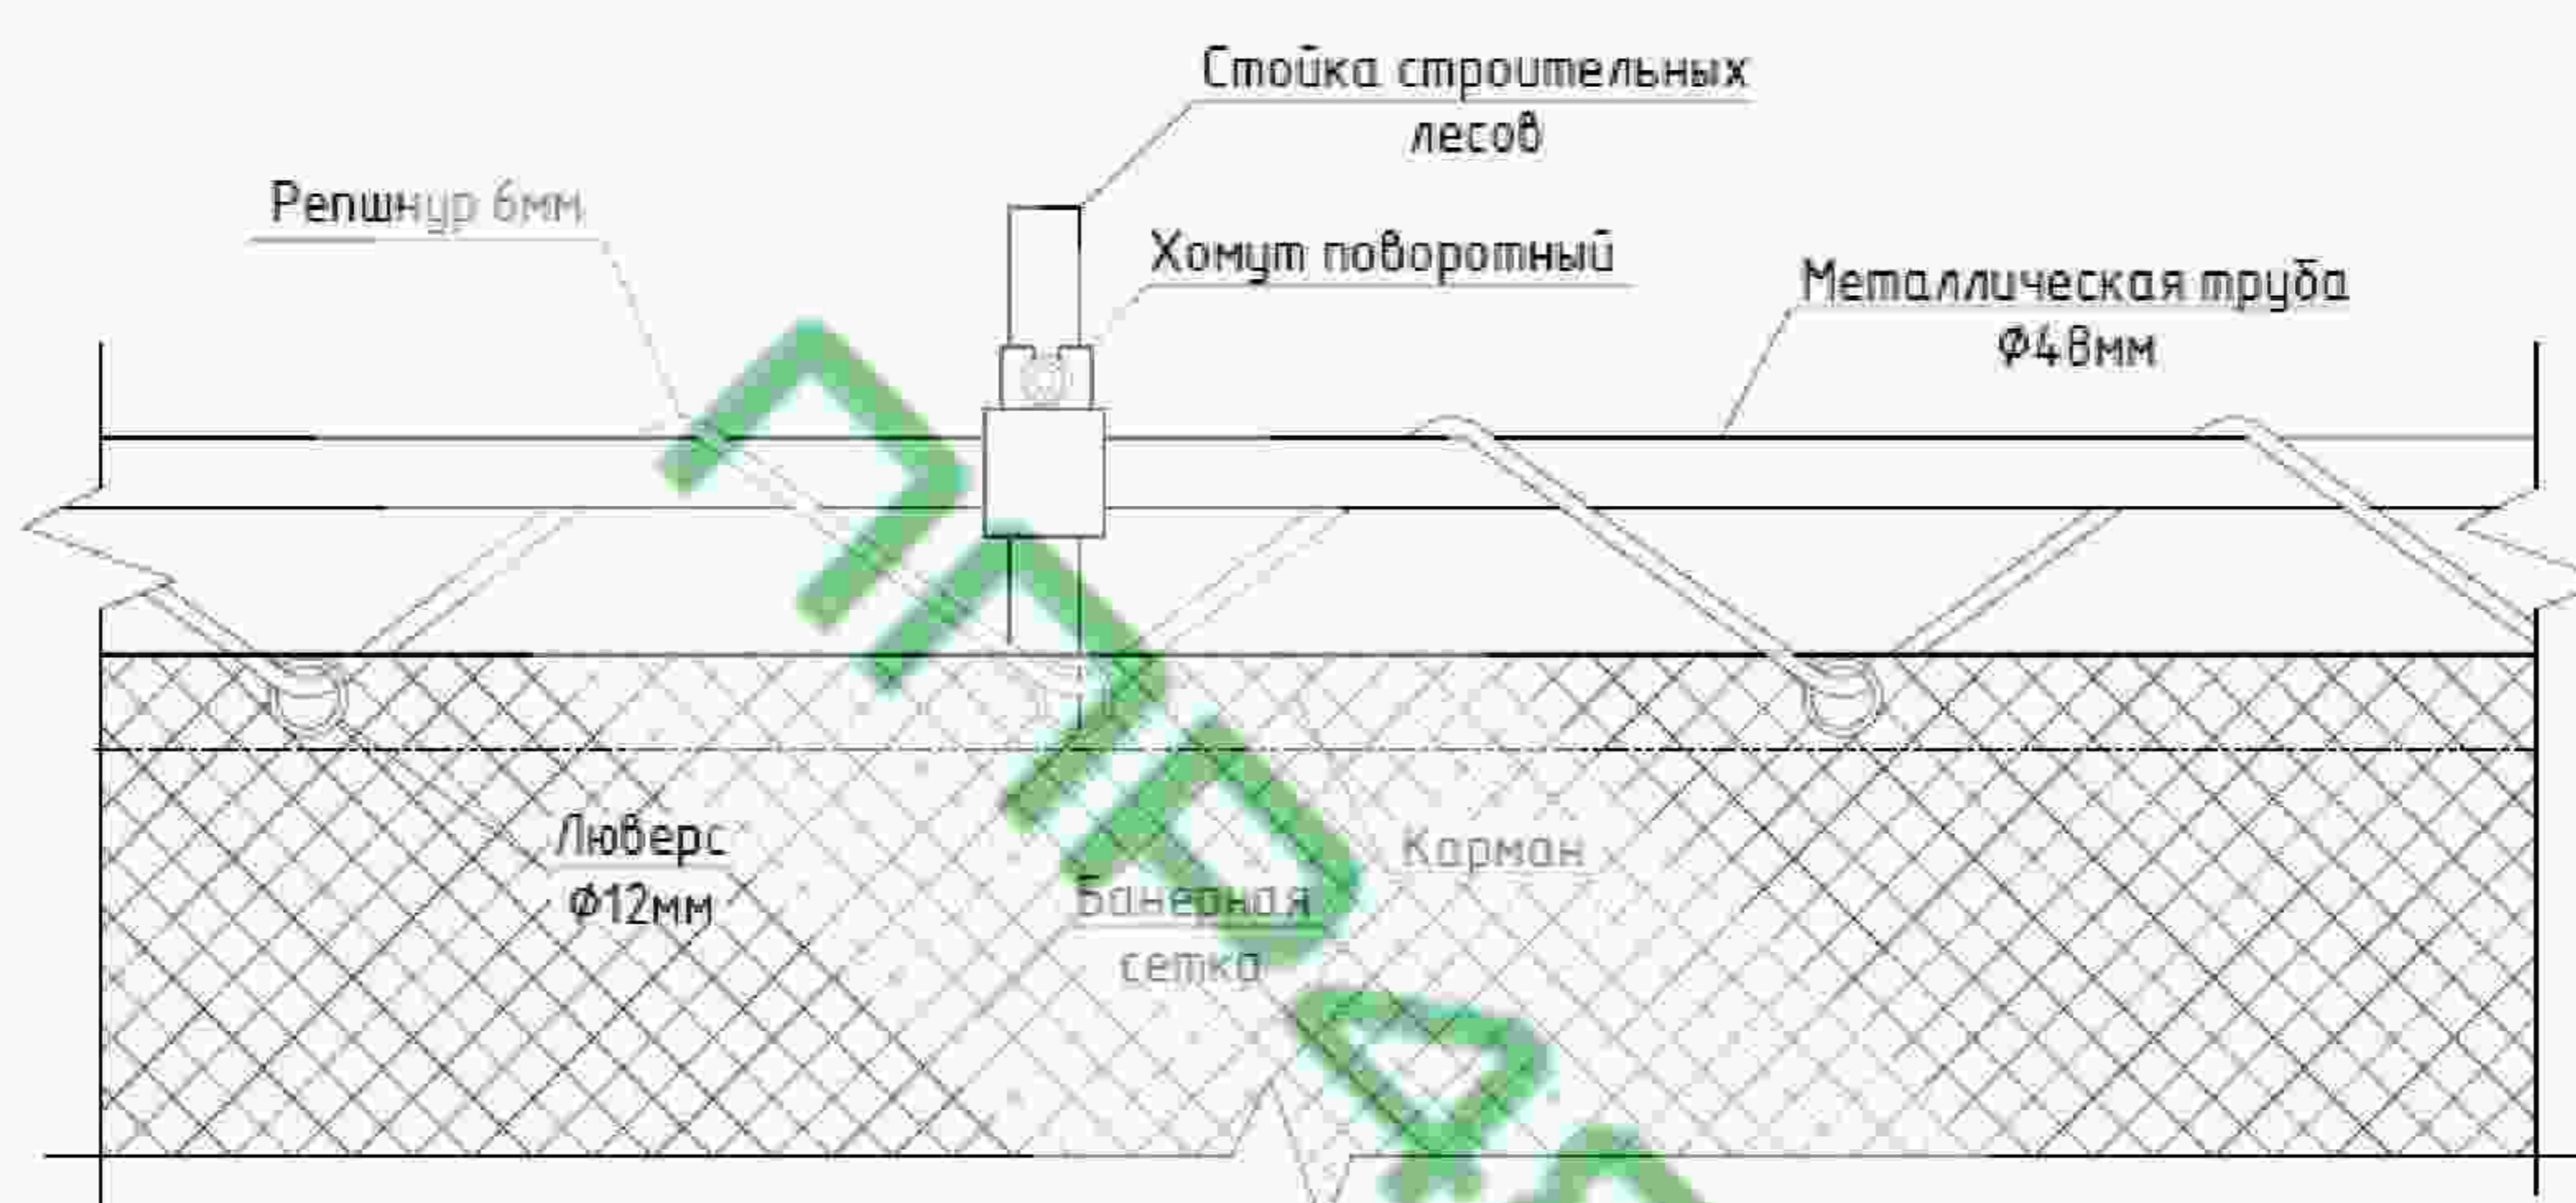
Узел крепления баннерной сетки к элементам строительных лесов
